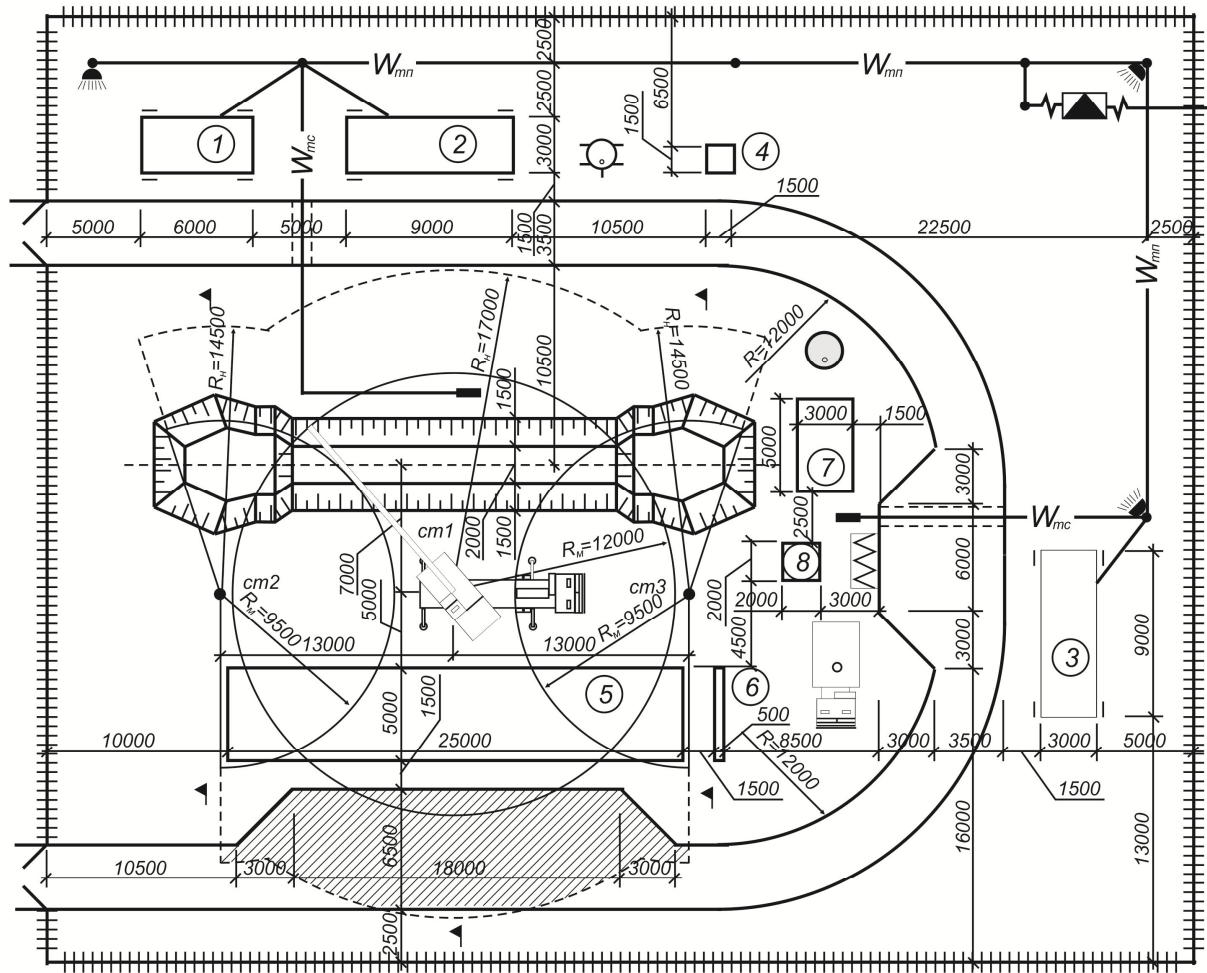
Будівельний генеральний план влаштування водоперепускної труби
